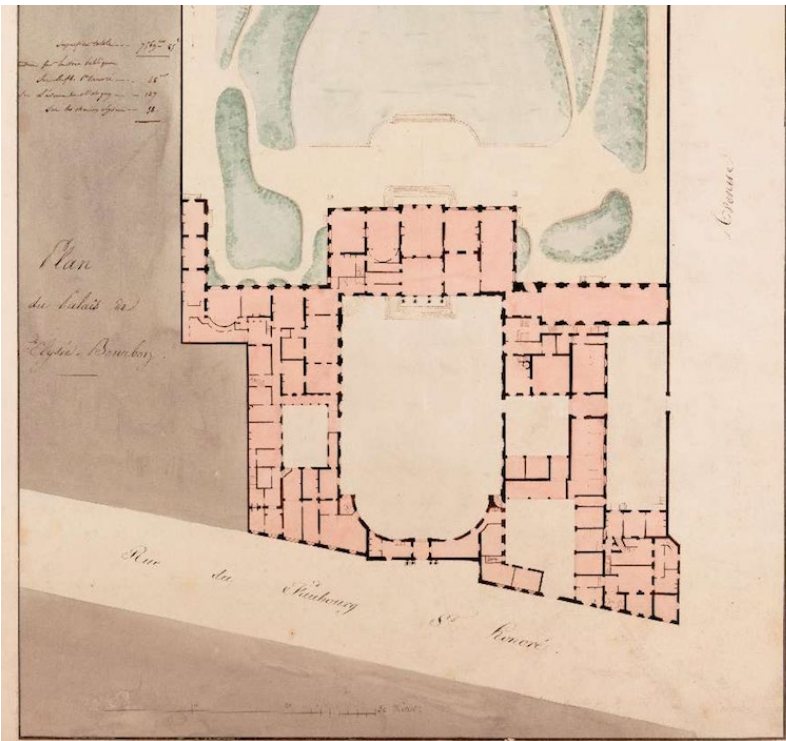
Détail du plan du rez-de-chaussée de l'Élysée-Bourbon en 1817 après les aménagements de l'architecte Pierre-Adrien Pâris. © Archives Nationales.
